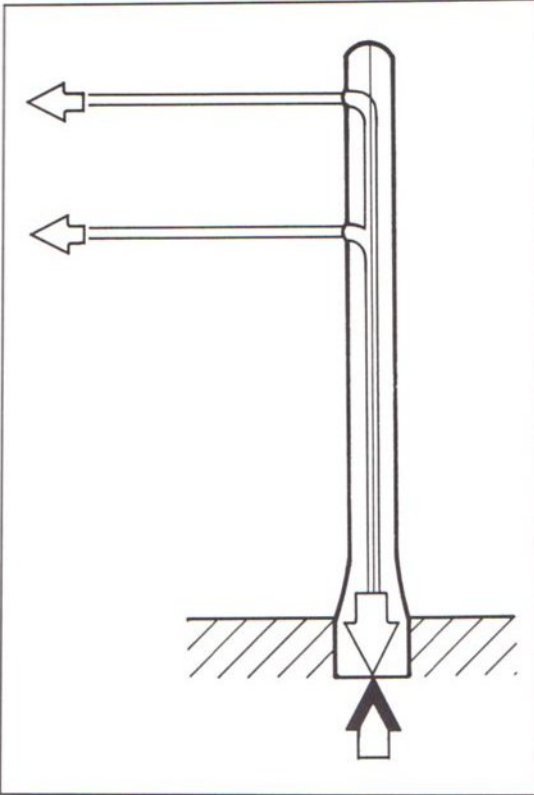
Zugkräfte (Oberleitungsdrähte) wirken horizontal auf die Stabachse ein, werden vertikal umgelenkt und abgetragen.
